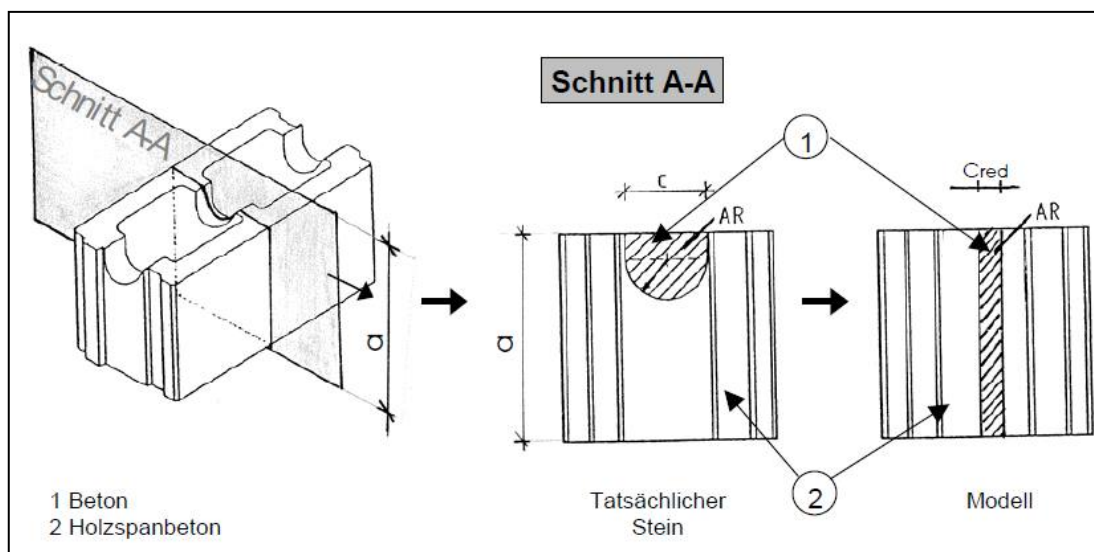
Ersatz der horizontalen Betonriegel A_R (Stegaussparungen) zwischen den Kammern der Betonsäulen durch modellhafte Rechteckflächen A_R
